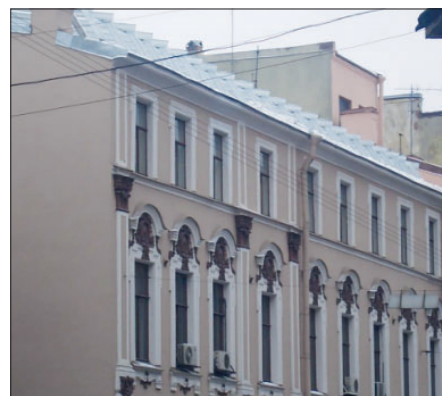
Надстройка этажа мансарды здания центрального офиса ОАО «Монолитстрой» на ул. Рылеева, 29
